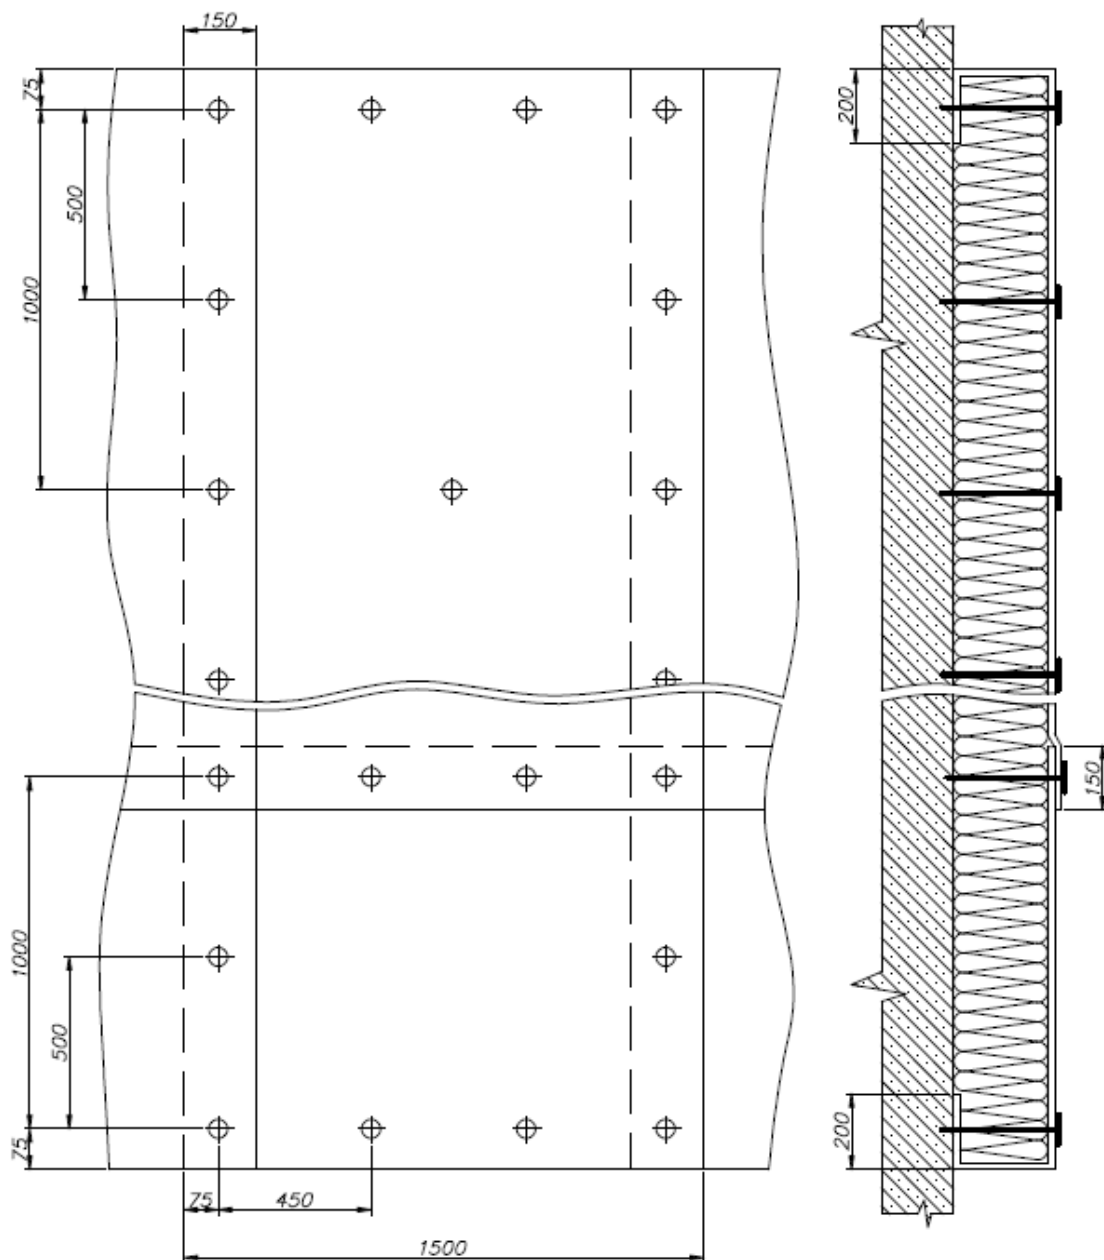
Схема монтажа гидроветрозащитной мембраны
